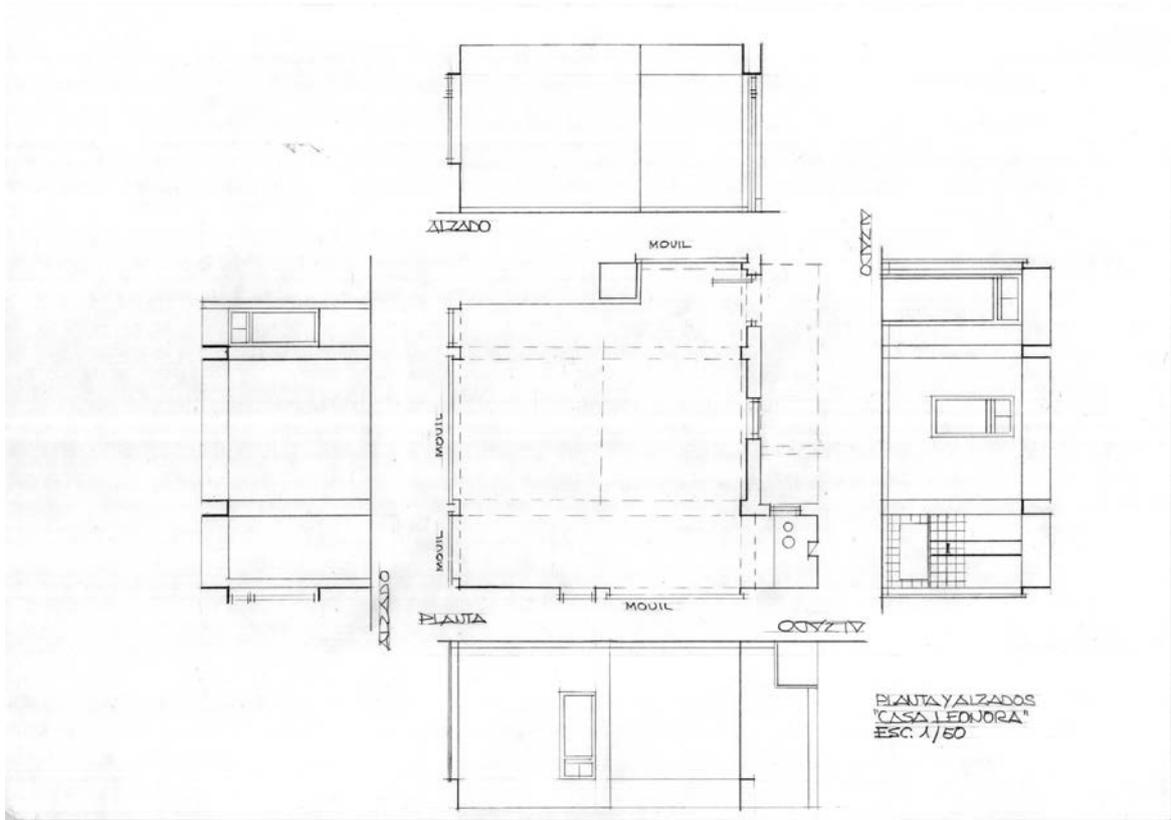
Planta y alzado de la casa de Leonora. Tinta sobre papel DIN-A2.
